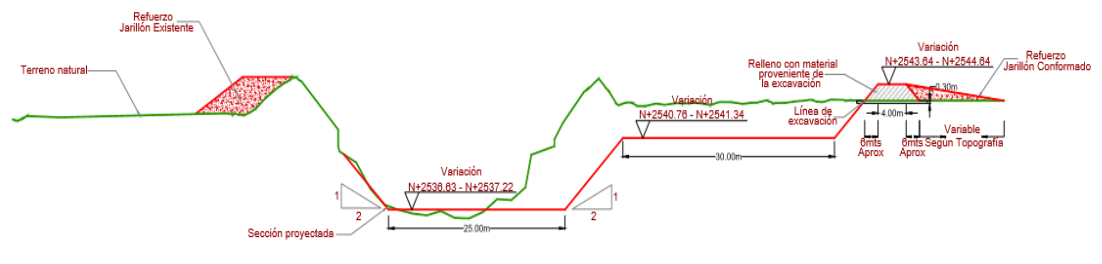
Sección típica 2 de corte transversal Fucha.
